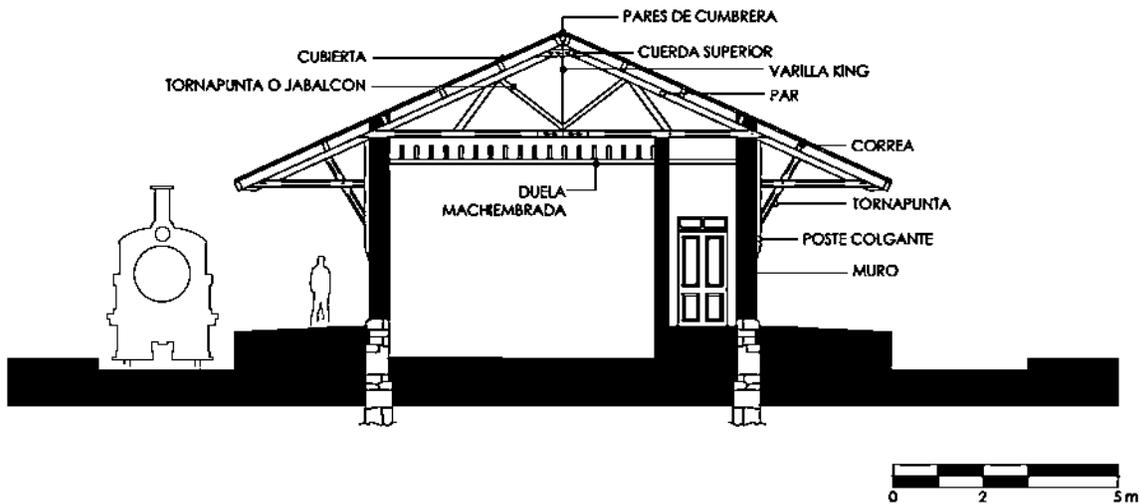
Sistema constructivo tipo de las estaciones, sección bodega de equipaje.
